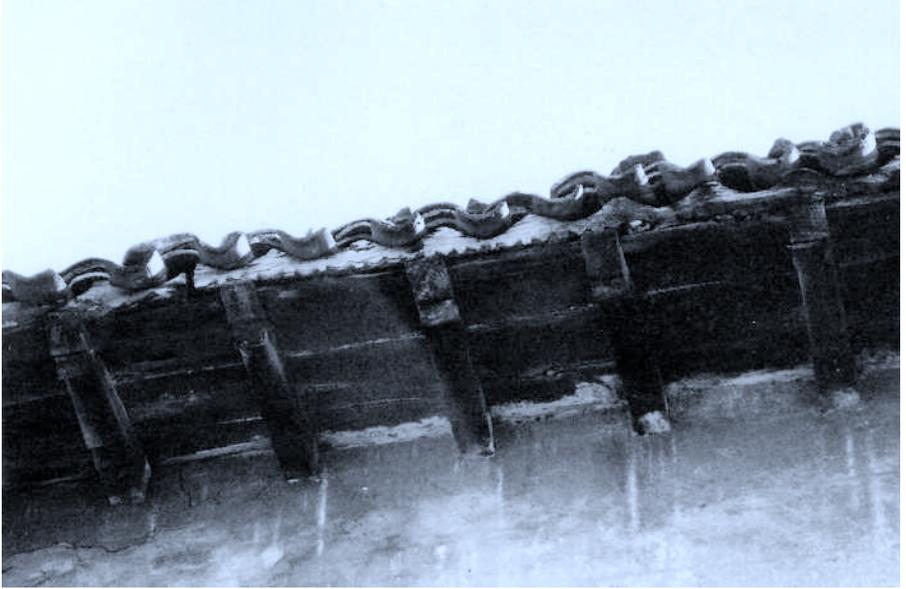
Ayuntamiento de Carranza proyectado por el arquitecto Rafael Fontán en 1938. Detalle del alero.
